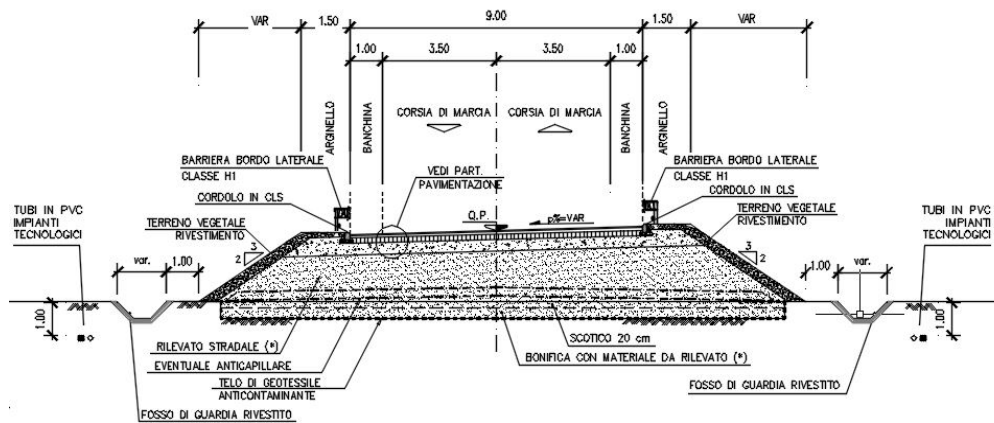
Sezione tipo rami di svincolo in rilevato.
